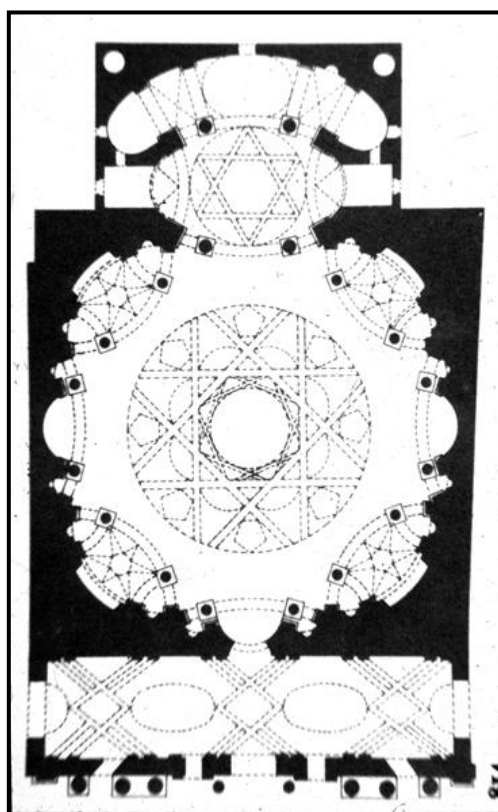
Planta de San Lorenzo, Turín. Paredes esculpidas.
